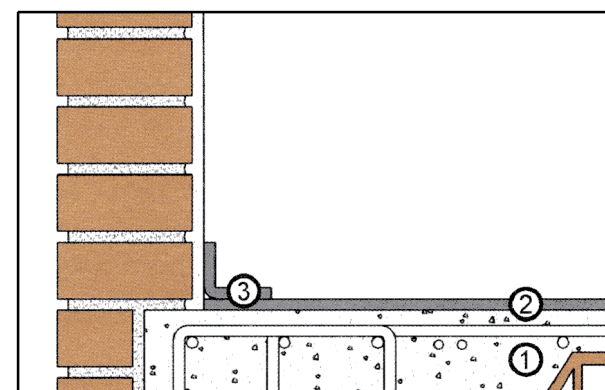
Separación del mortero con el cerramiento de fachada o con la medianería mixta mediante banda perimetral.
